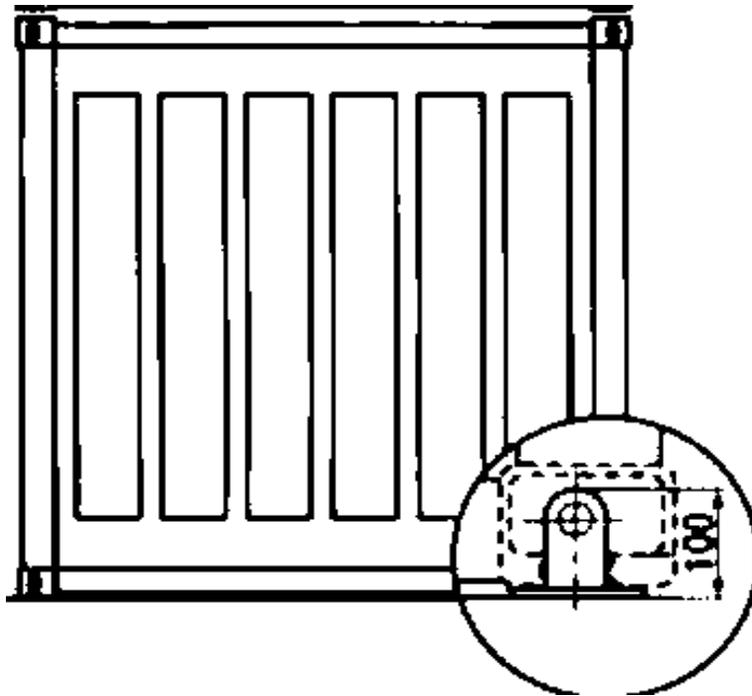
Detalle cono de apilamiento. The Standard. 2012.
